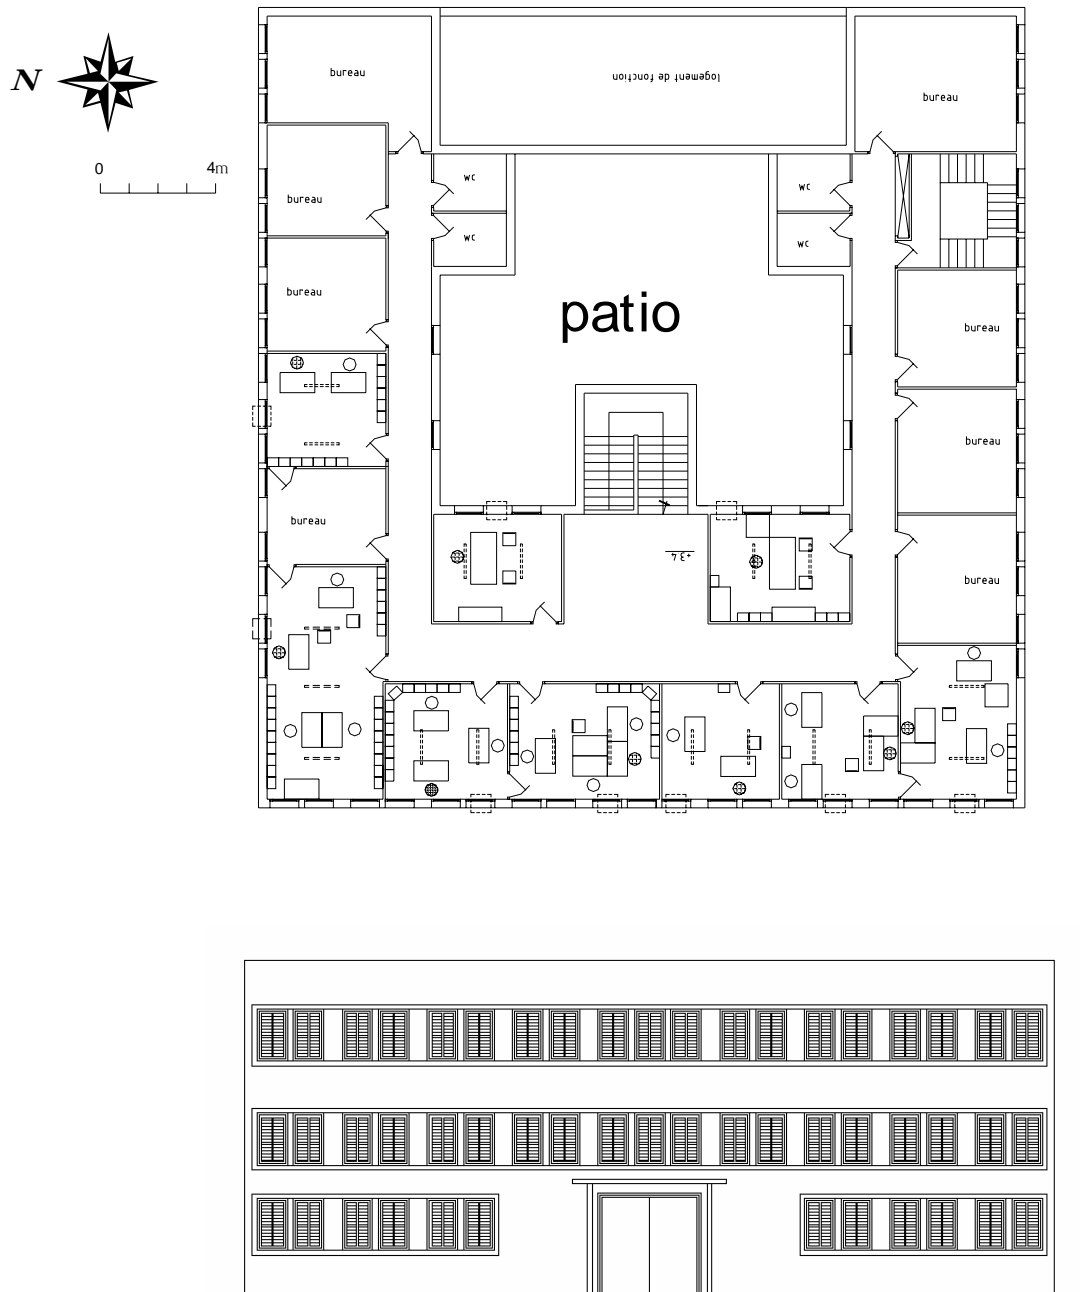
impôts*, le plan du 1^{er} étage et la façade principale orientée ouest
